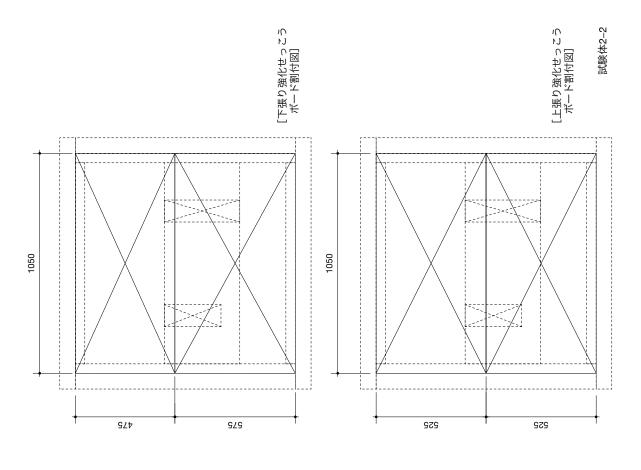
試験体 2-2 壁-床取合い部 試験体図
